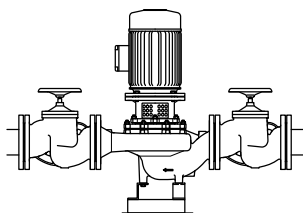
Vertikal konstruksjon/festing med 3 vinkelføtter (stål 37, tilbehør), dimensjoner 032-032-160 til 100-100-125
